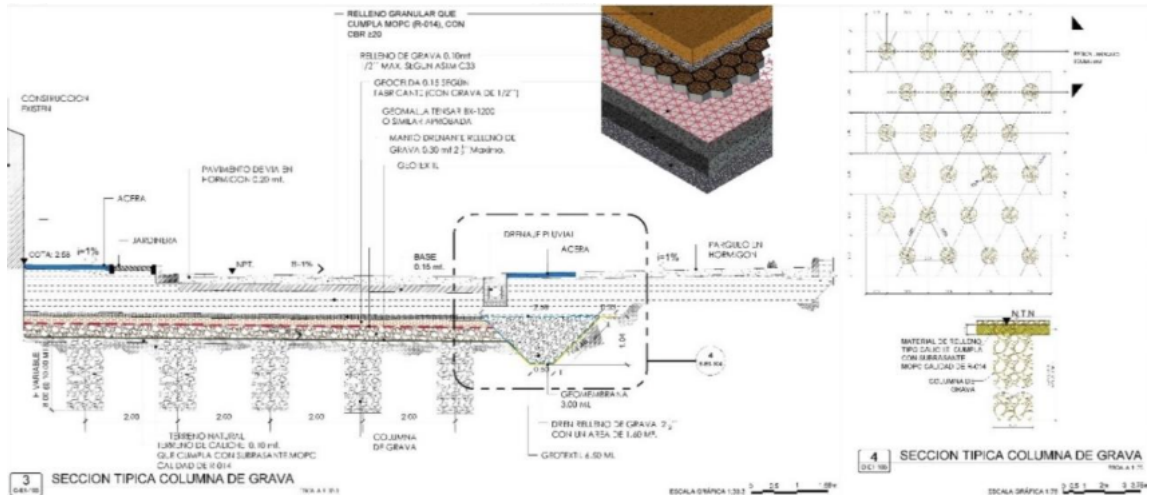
Detalle de construcción de columnas de grava. Fuente: URBE, octubre 2025.
